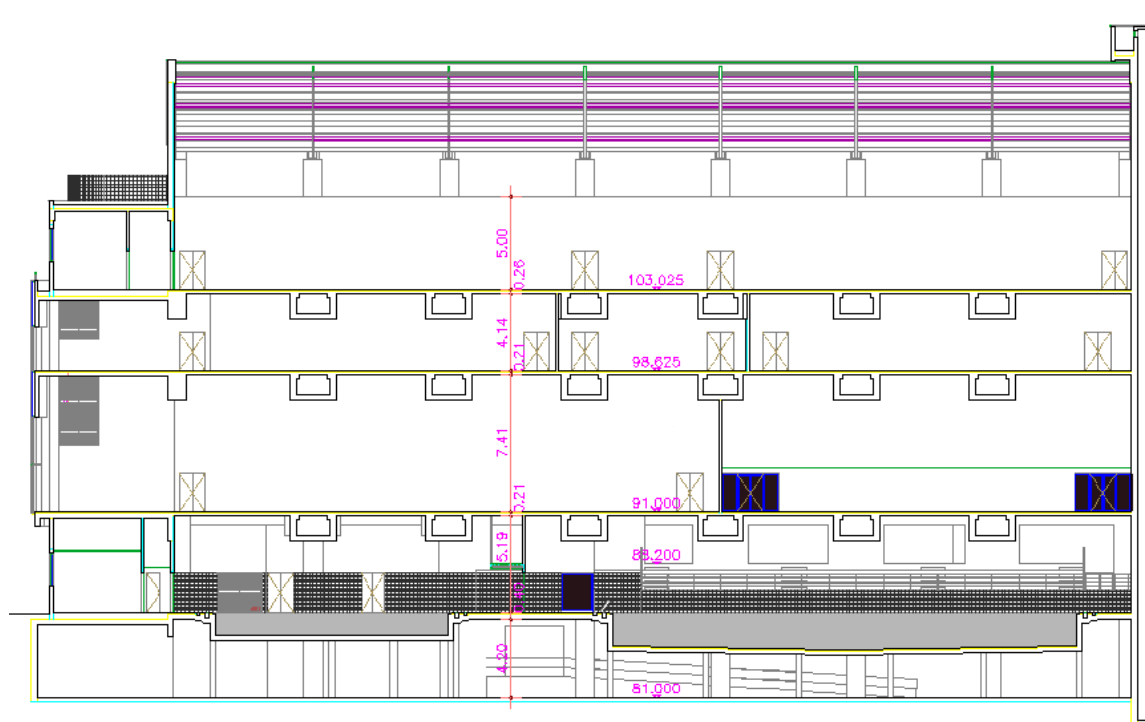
Corte longitudinal do pavilhão Multidesportivo do SCP.
